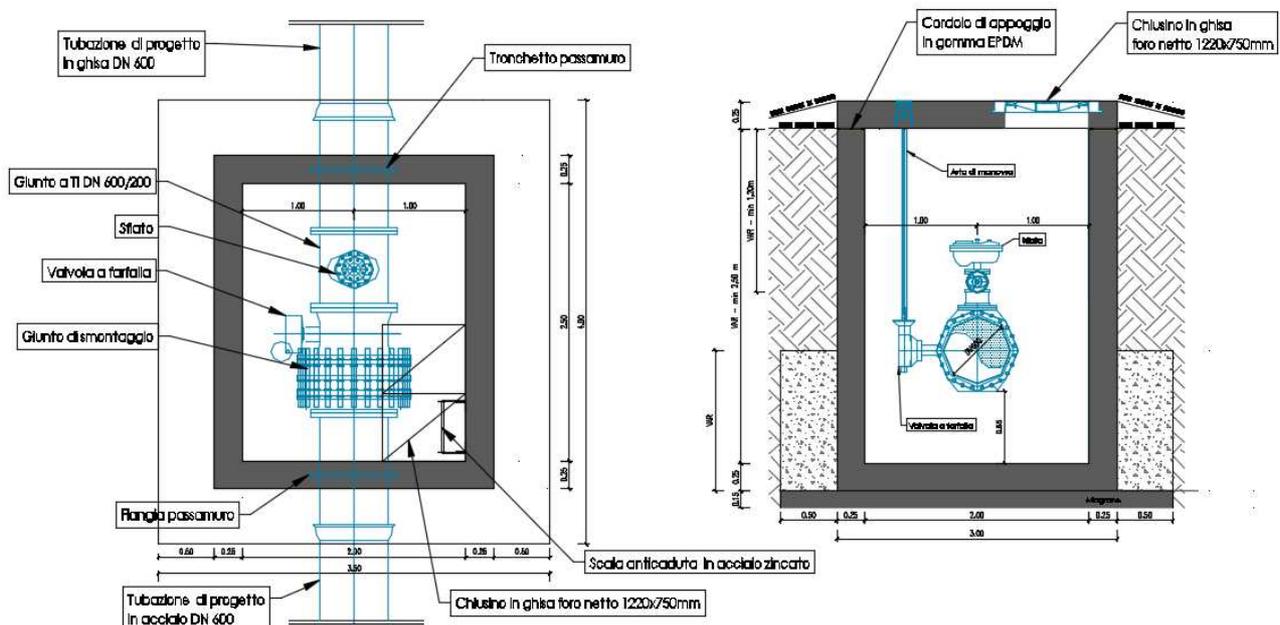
Pozzetto di sfiato – Pianta e profilo
